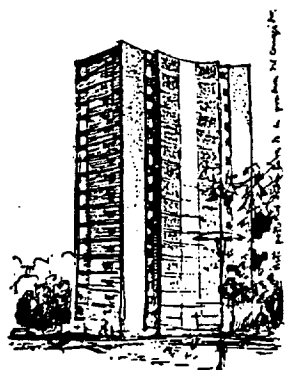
VIVIENDAS TIPO GRAN SAN BLAS
